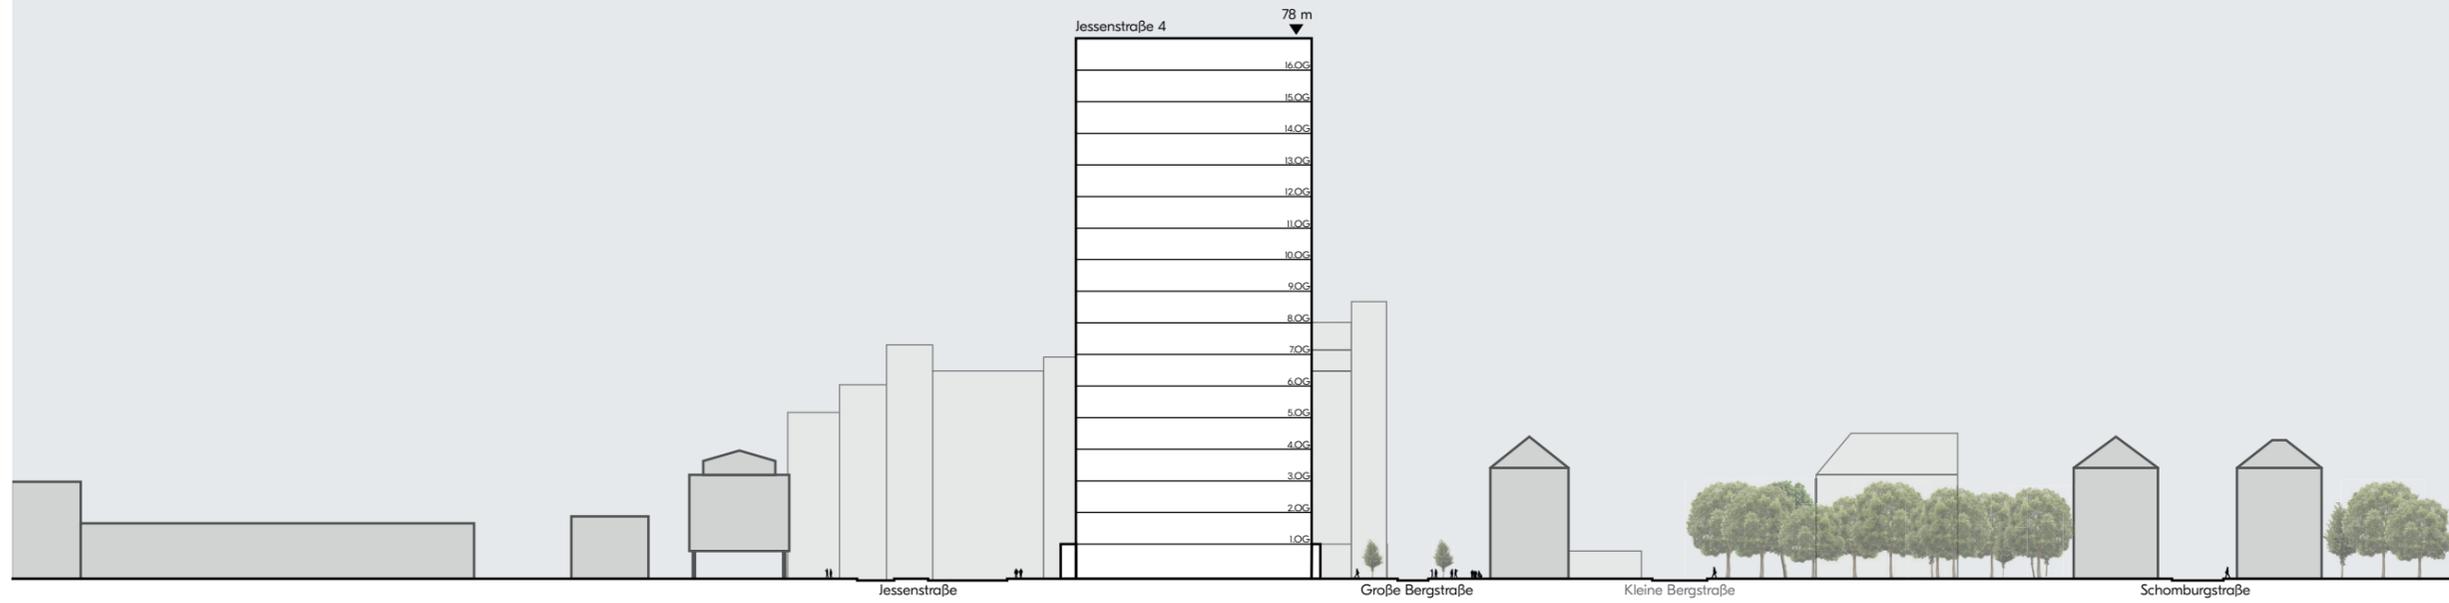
Schnitt 1 - Jessenstraße 4
